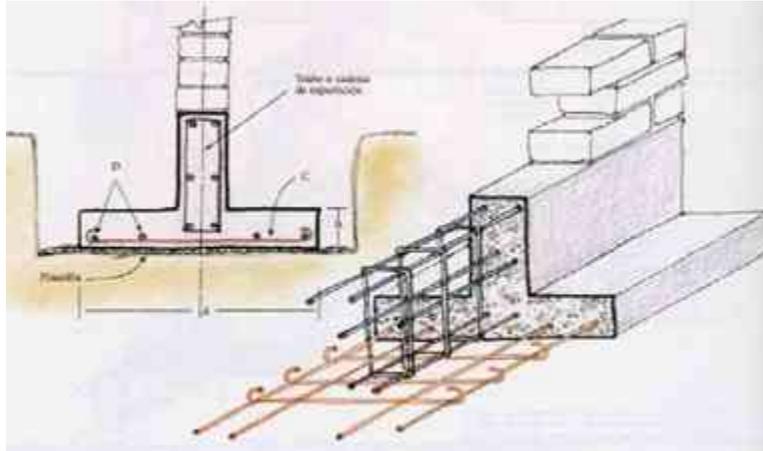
Zapata corrida. <http://www.elconstructorcivil.com>
